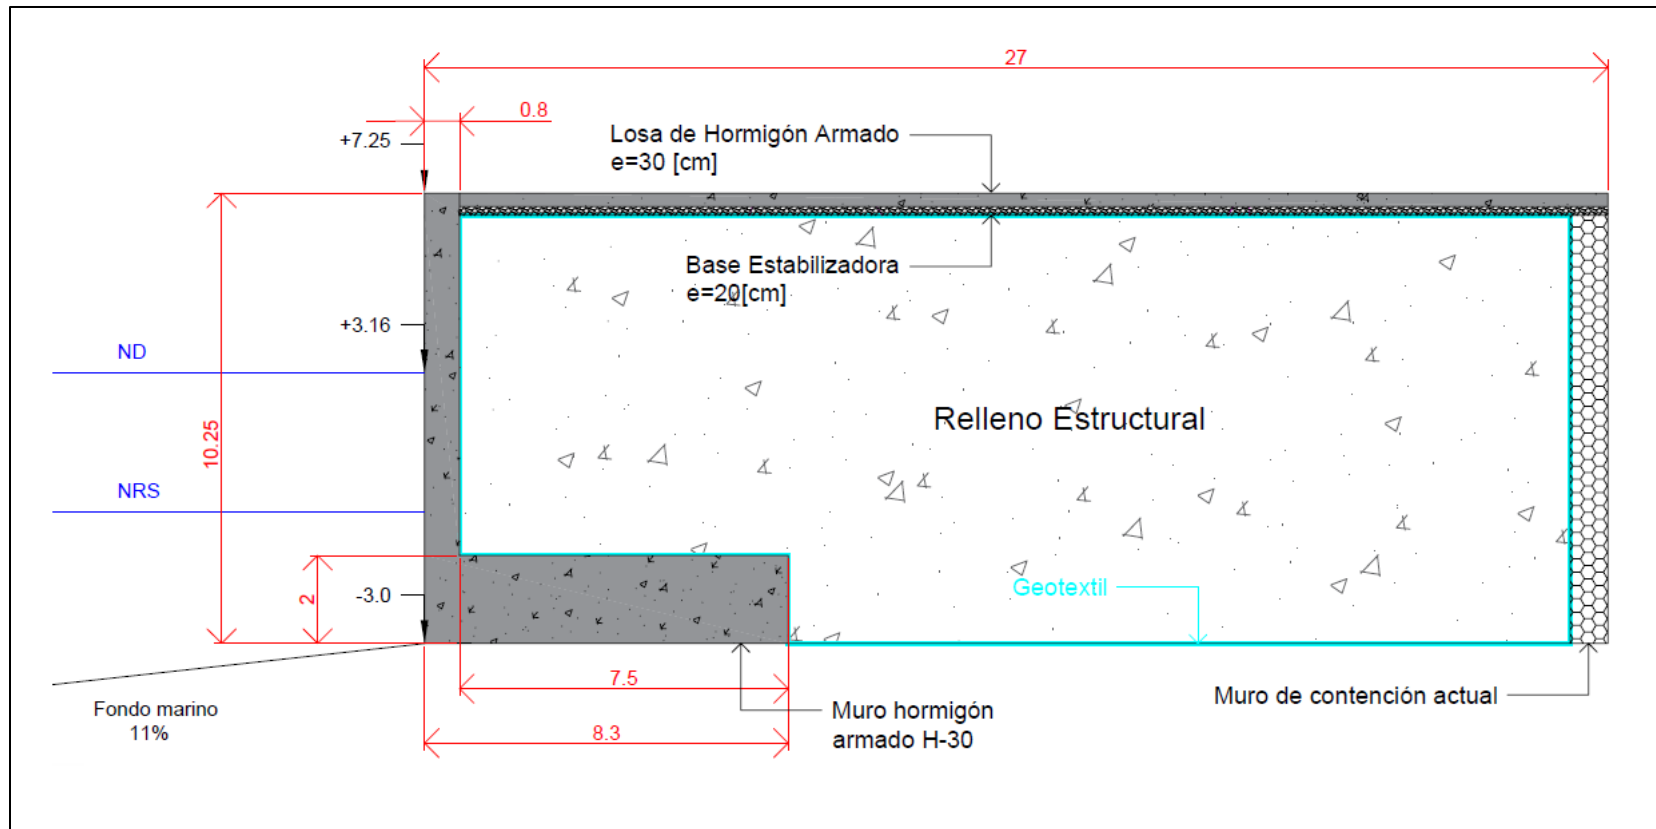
Plano perfil muro cantiléver. Fuente: Elaboración propia en Autocad.
